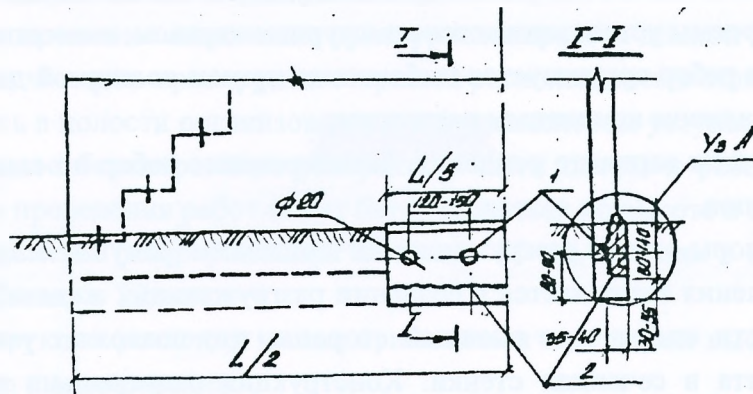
Усиление опоры-стенки в продольном направлении: 1 – бетонная шпонка; 2 – железобетонная рубашка усиления; 3 – арматурный каркас.
